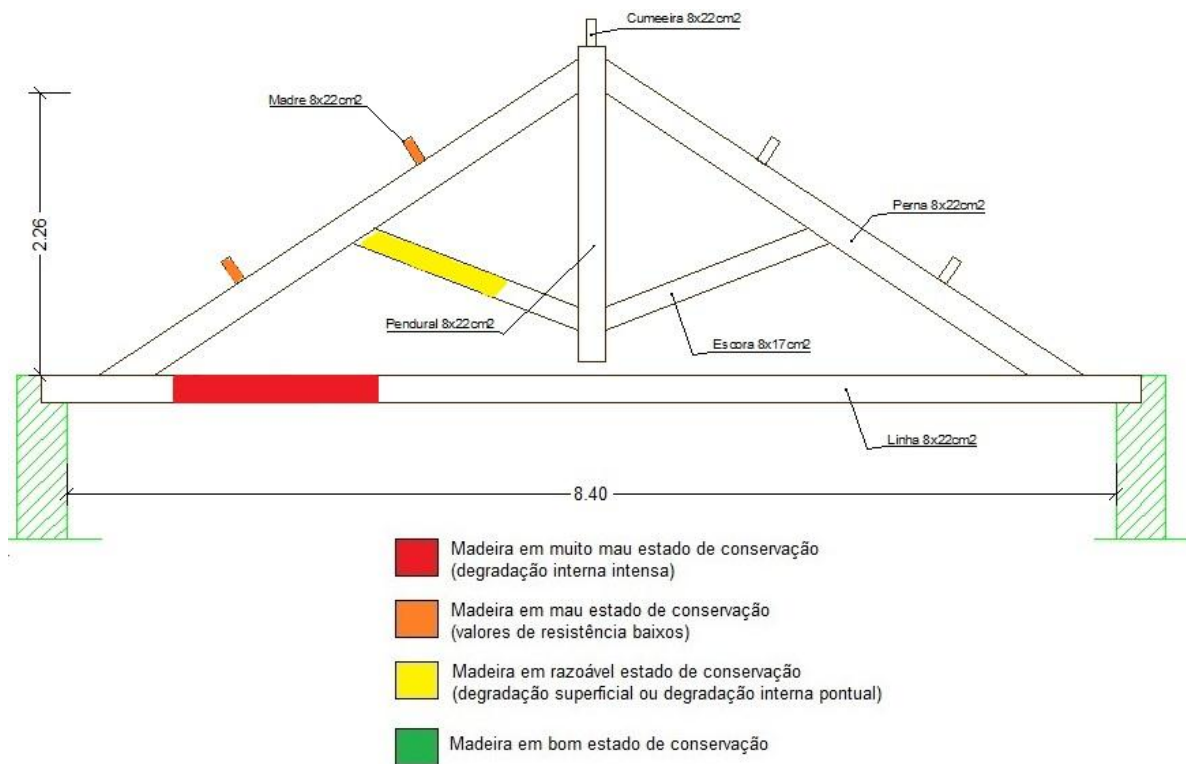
Esquema de degradação das vigas de madeira da cobertura
